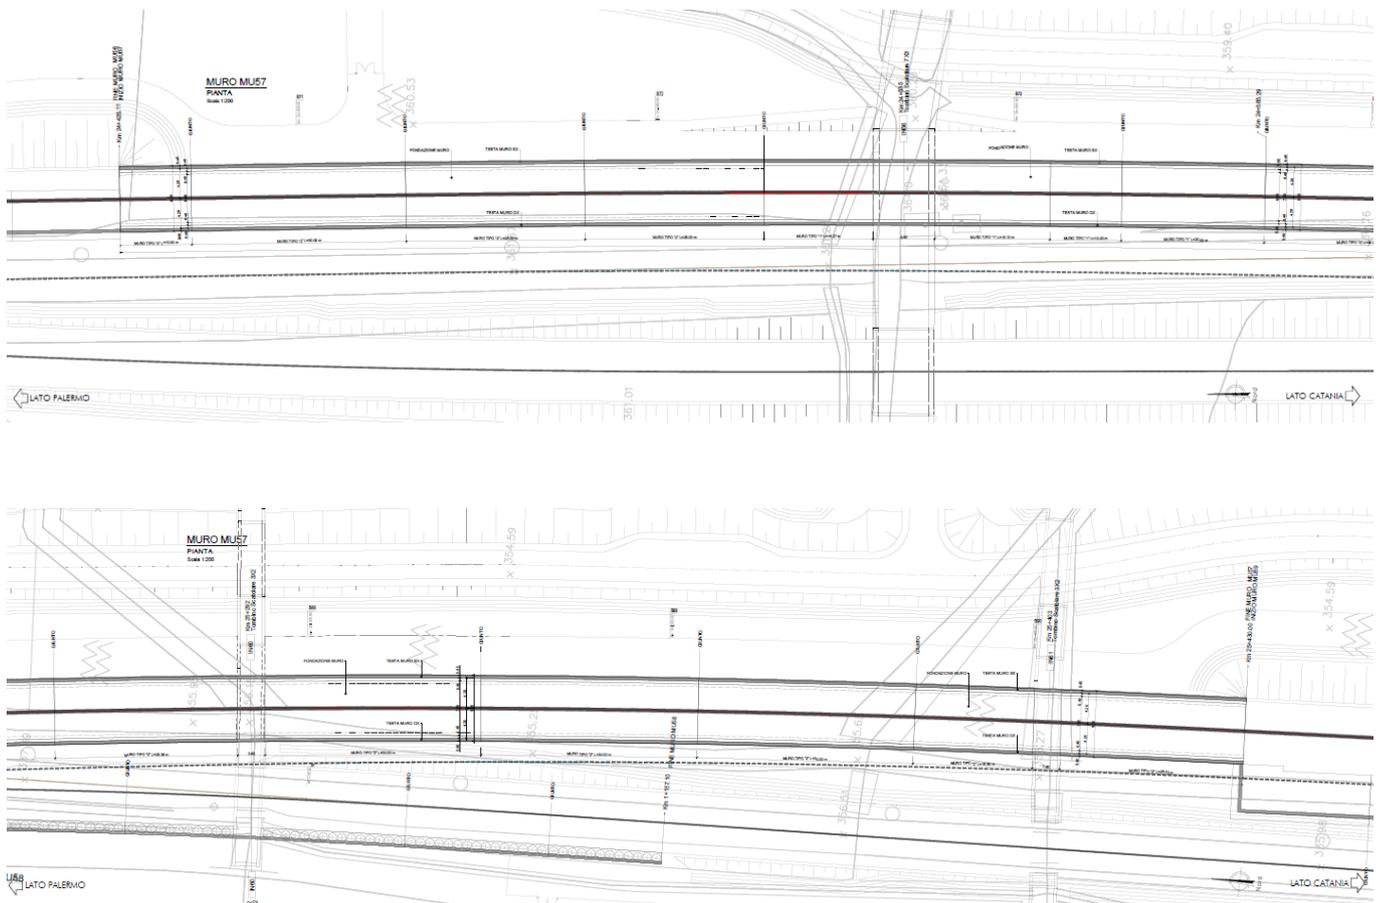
RI12: Muro a U MU57 – Pianta.
